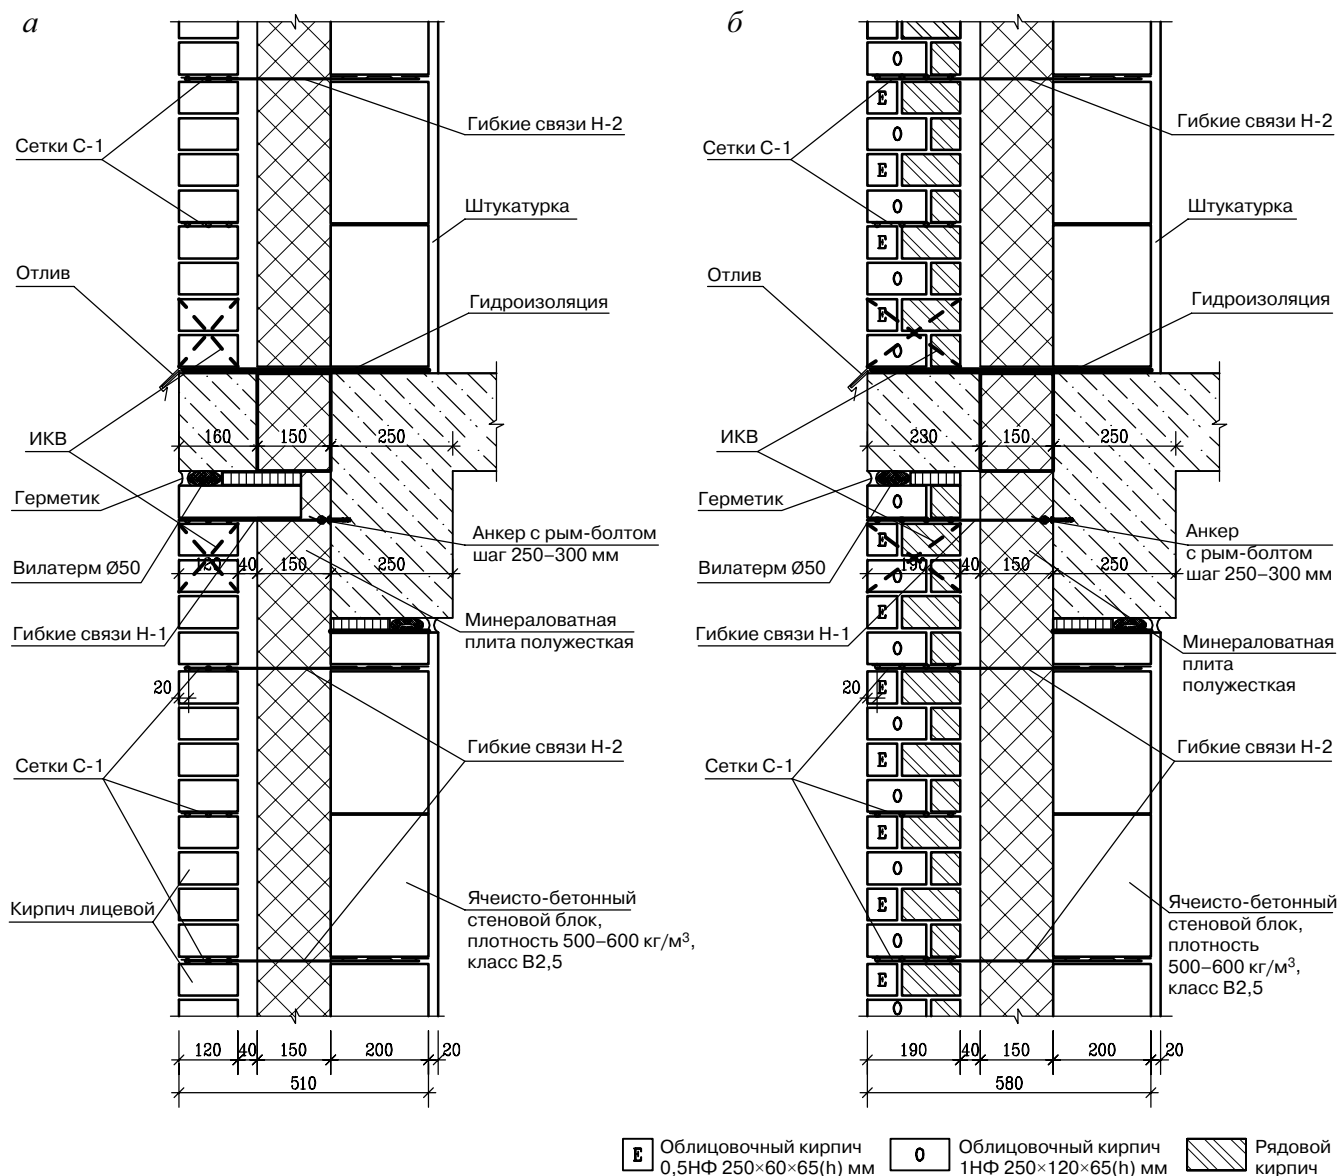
Пример трехслойной наружной стены с внутренним слоем из ячеисто-бетонных блоков: а – толщина облицовки 120 мм; б – толщина облицовки 190 мм
